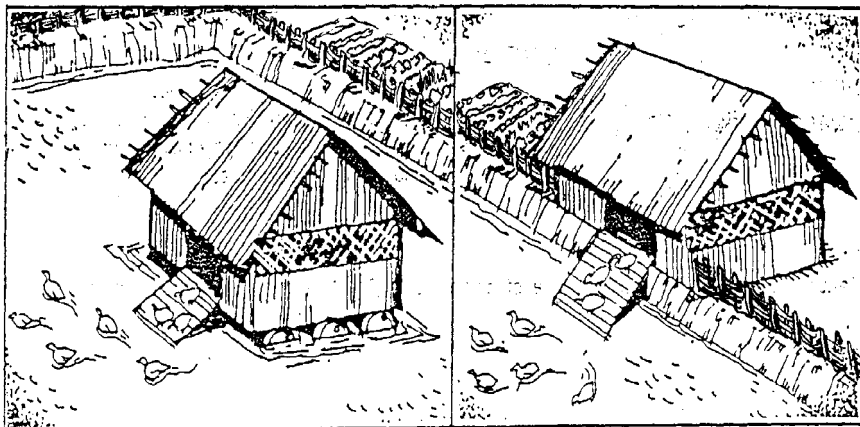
Construction d'une canardière au-dessus de l'étang ou sur la digue.
